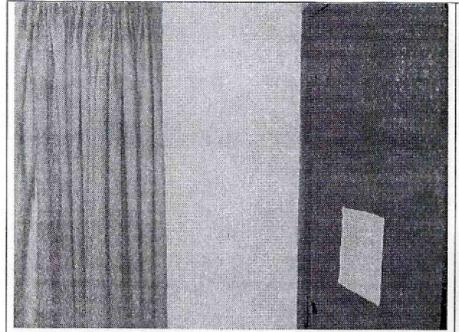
Muros, entrepiso y vigas sin daño evidente.
